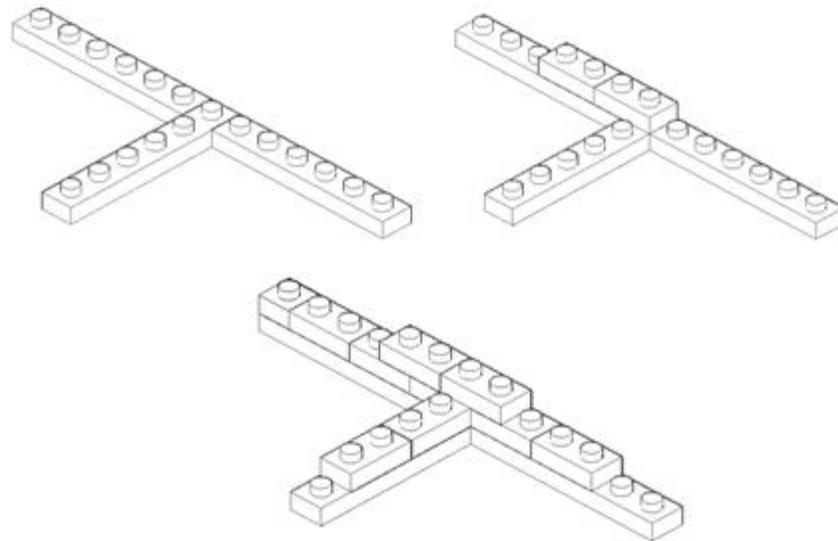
Forma de realizar un muro en T. Fuente: Elaboración propia (2016)
